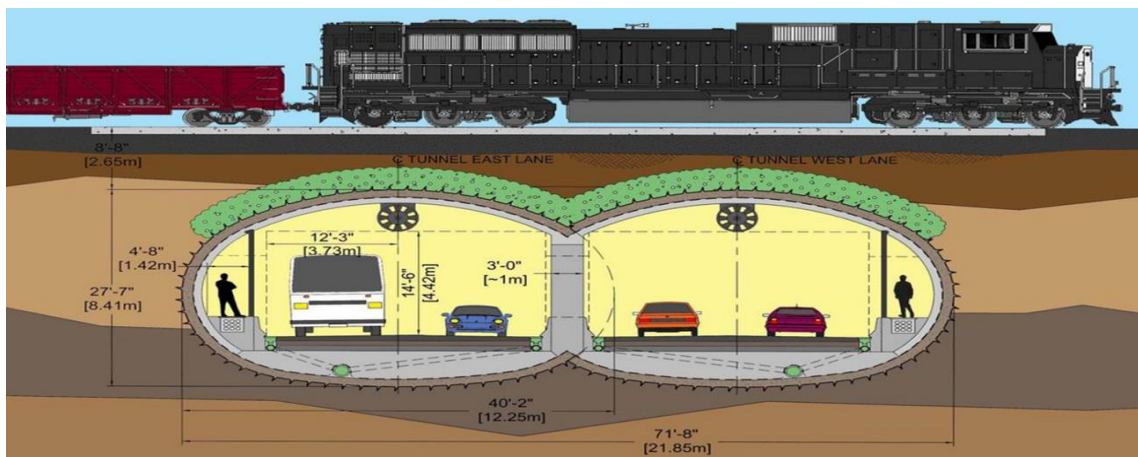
Proposta genérica da seção transversal (Sauer, 2004).
